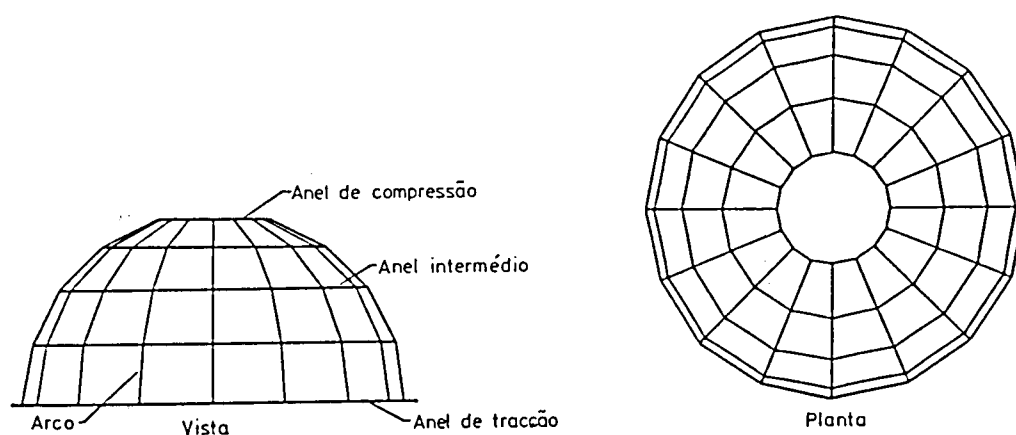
Representação da vista e da planta de uma cúpula raiada
